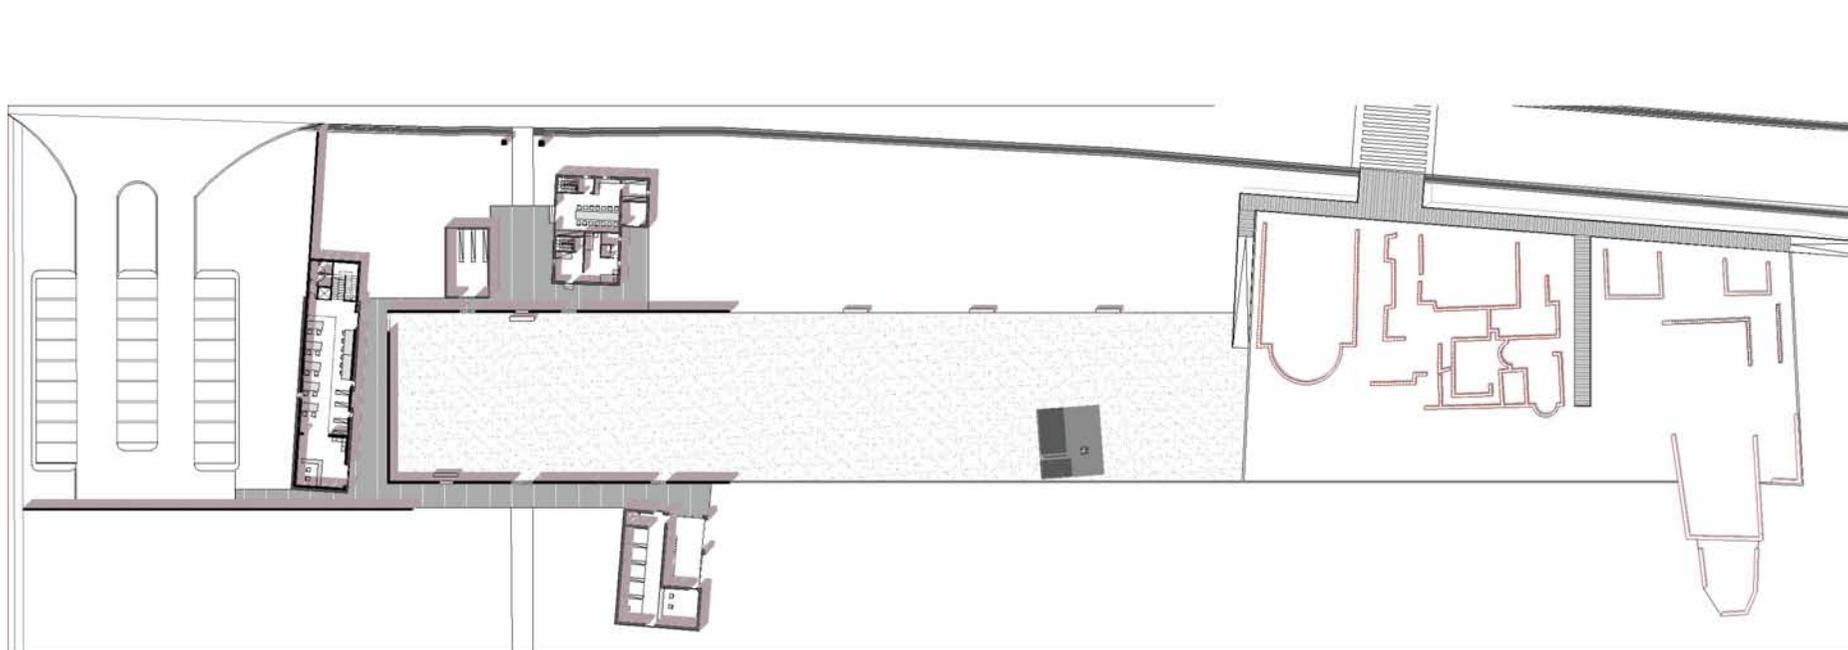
Pianta della corte rurale adibita a centro ricerca
